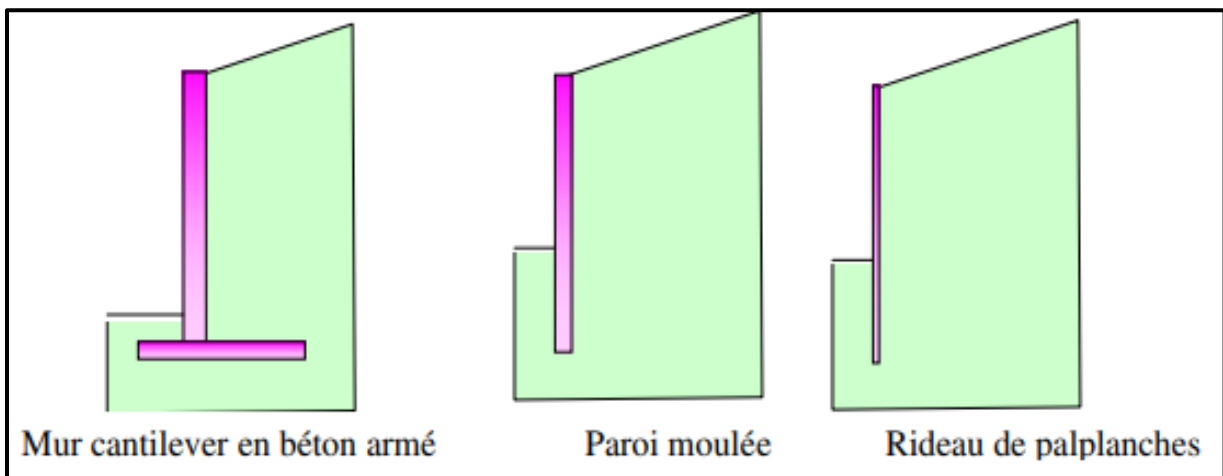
Des ouvrages qui Représentent la poussée grâce à l'encastrement.
